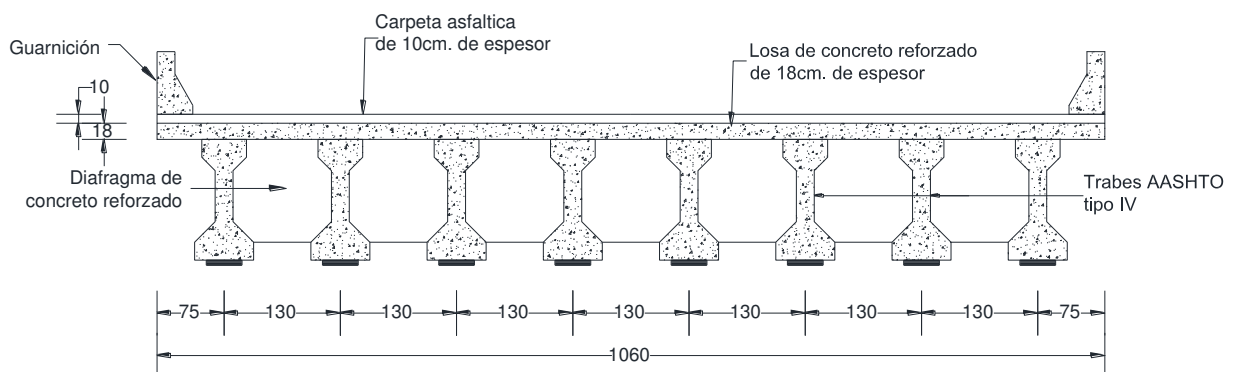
Sección transversal de la superestructura, acotada en centímetros.
